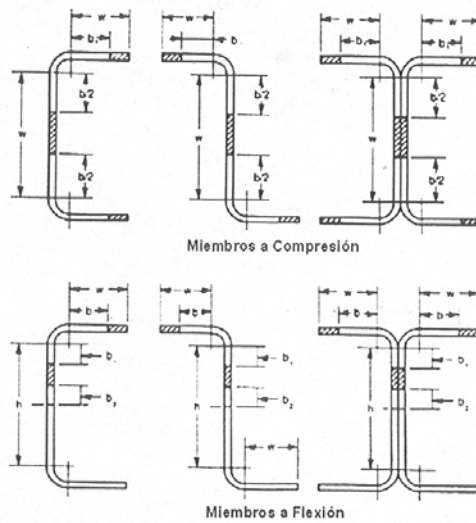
Anchos efectivos de perfiles con elementos a compresión no atiesados.
